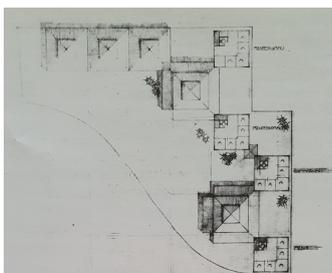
1959. Pianta piano secondo della seconda bozza di progetto (fonte: Guerra A., Morresi M., Gabetti ed Isola... cit., p. 67)
